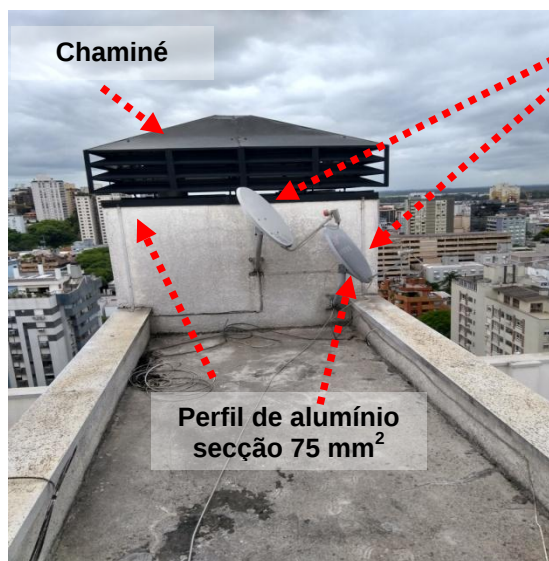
e 13: Malha captora natural - Capas de muro instaladas no entorno da cobertura da edificação, em cota mais baixa.
